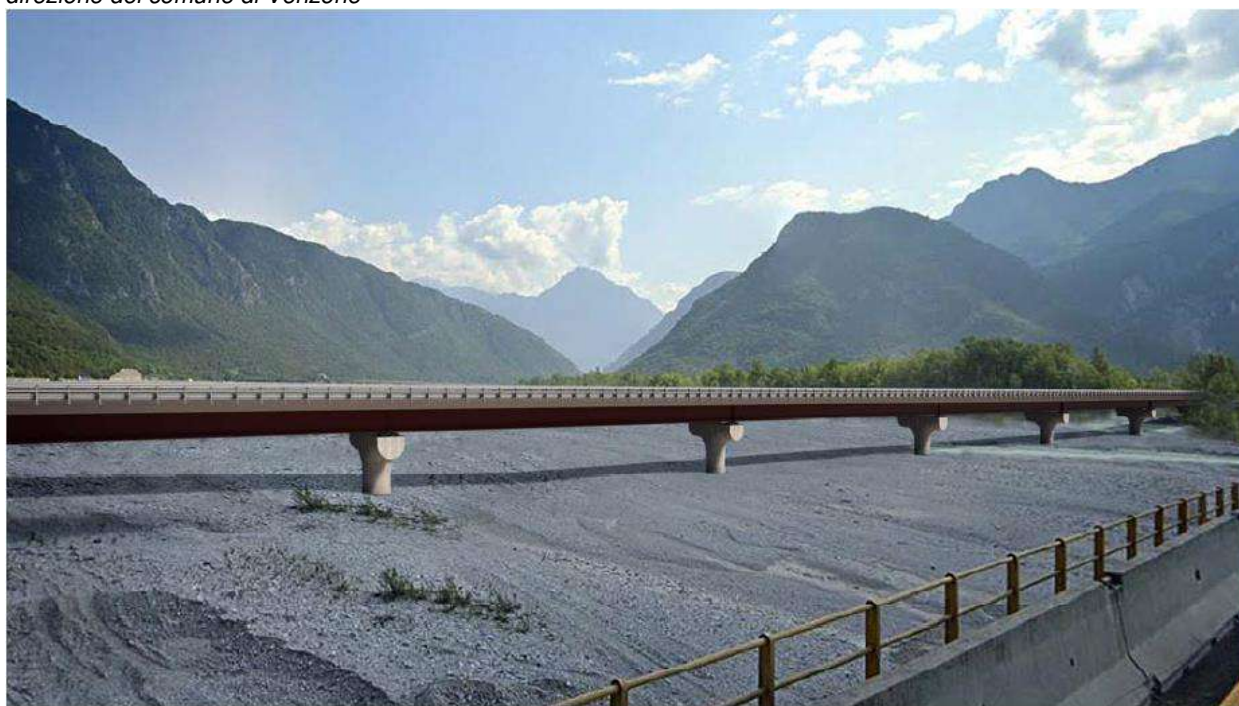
Vista n.4 STATO DI PROGETTO - Foto inserimento con vista presa dall'ex ponte ferroviario verso il ponte oggetto di intervento in direzione del comune di Venzone
